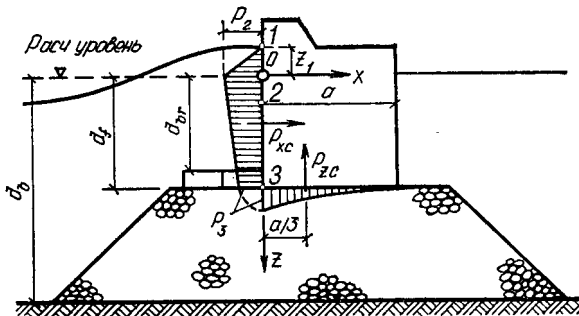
Эпюры давления разбивающихся волн на вертикальную стену и ее подошву
